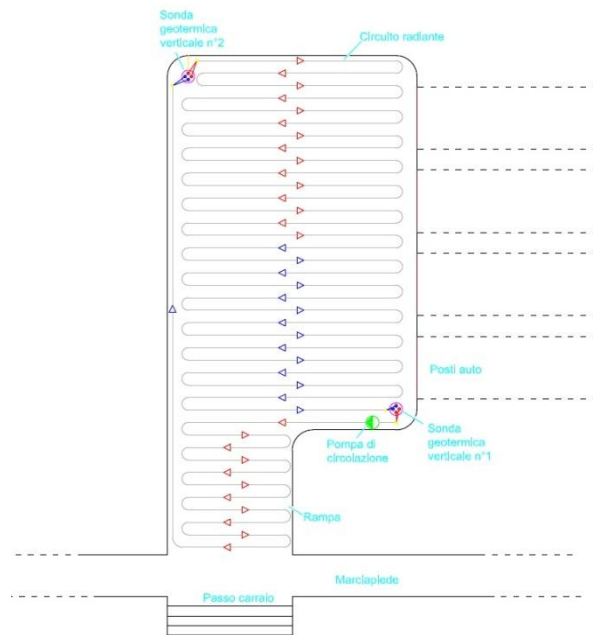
Progetto di Geothermal Snow Melting: pianta delle serpentine sotto il manto stradale della piazzola e ubicazione delle sonde geotermiche verticali
